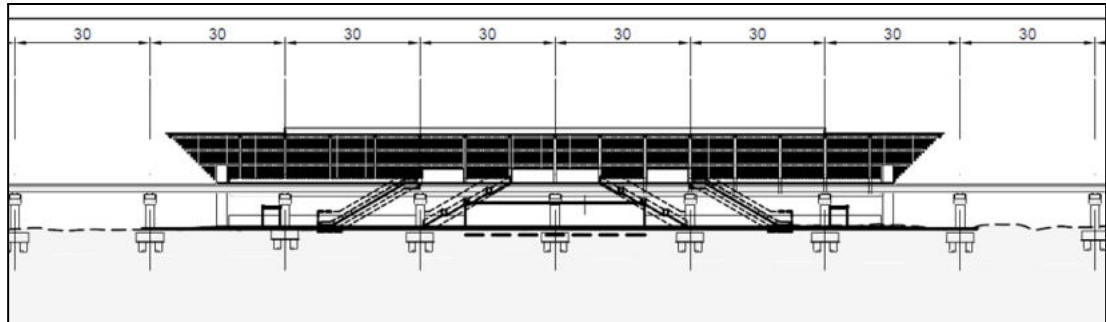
Perfil longitudinal del viaducto elevado en la zona de la Estación E11
